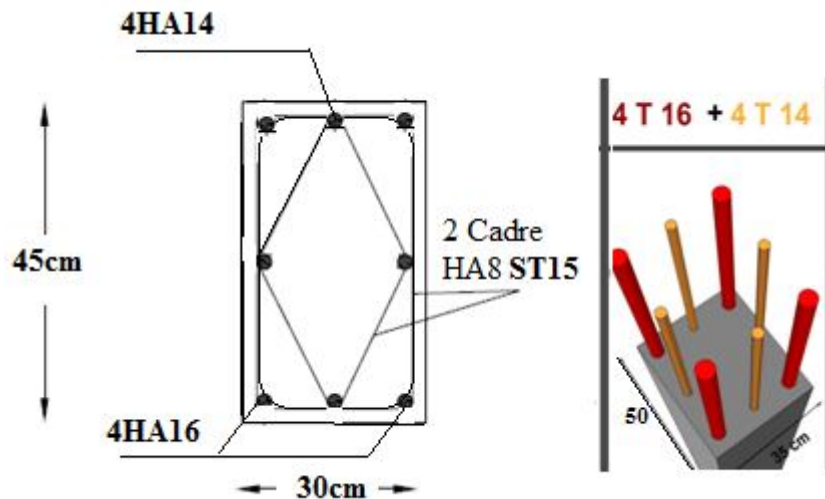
Dispositions des armatures de poteau (30.45) cm<sup>2</sup>
